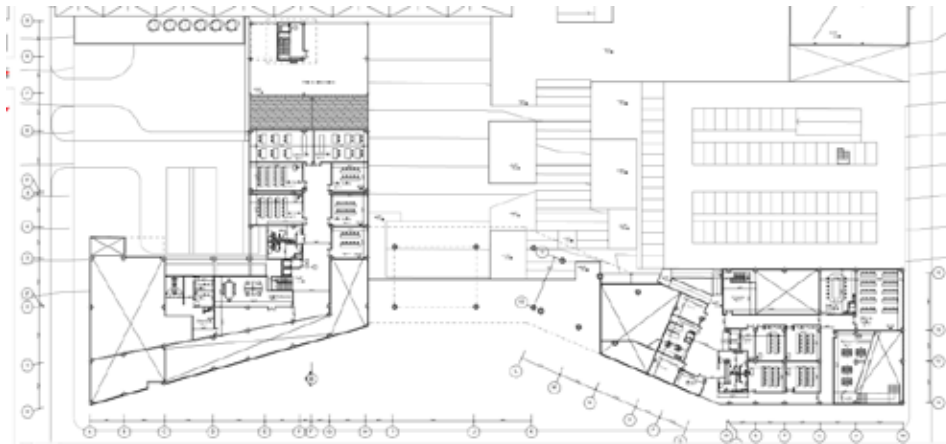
Vista Planta Nivel +4.50 - Malavé (2017)
